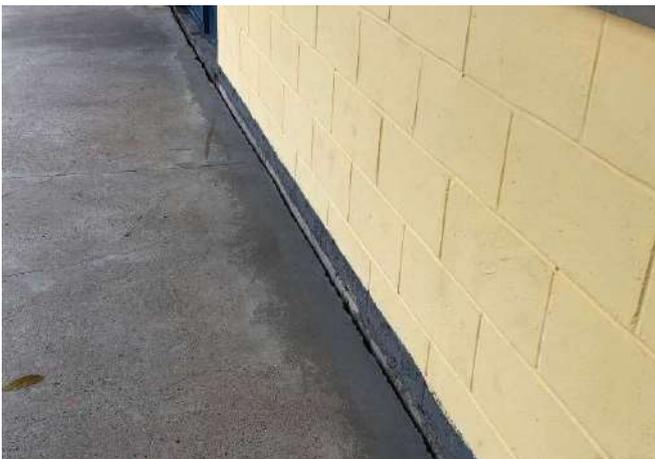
PASSEIO INTERNO, PISO CIMENTADO APRESENTA FISSURA.
